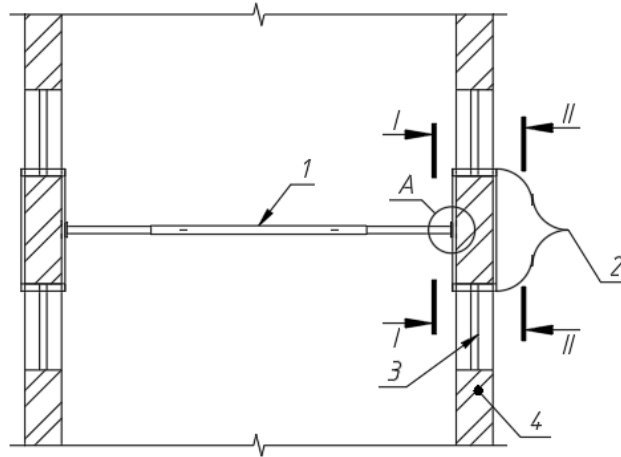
Конструкция для временного усиления кирпичных стен с проемами при демонтированных перекрытиях на виде сверху: 1 – стальная распорка; 2 – стальная обойма; 3 – оконный проем; 4 – простенок
